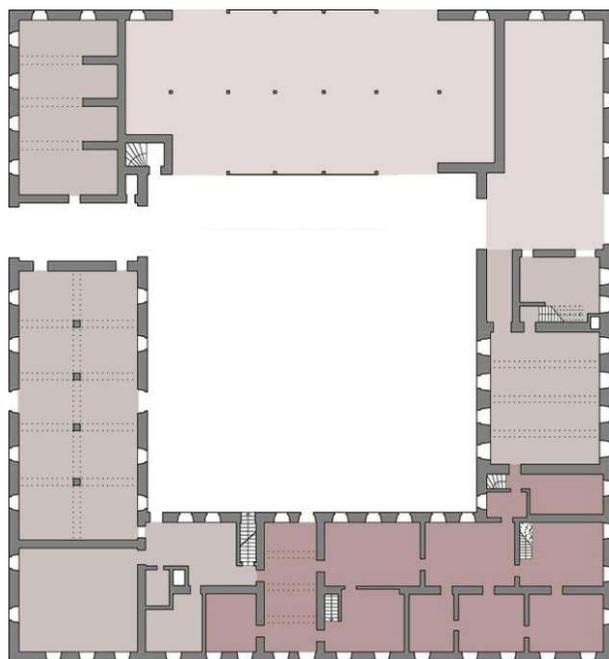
| Vierkanthof Grundriss Erdgeschoss
